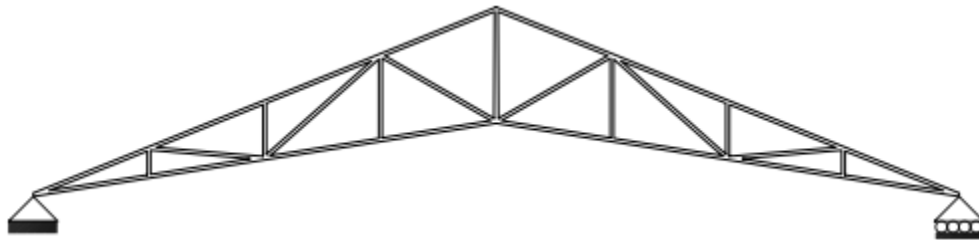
Variante 2 de armadura de cubierta tipo tijera
